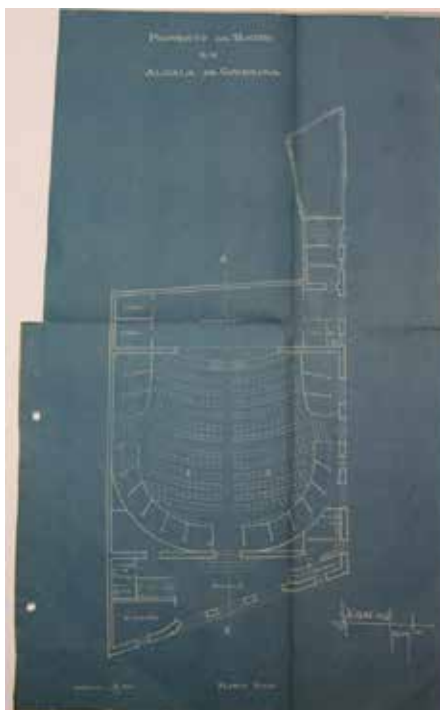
Teatro. Alcalá de Guadaira. Plano de la planta baja. J. Talavera Heredia. 1928 (AMAG).
